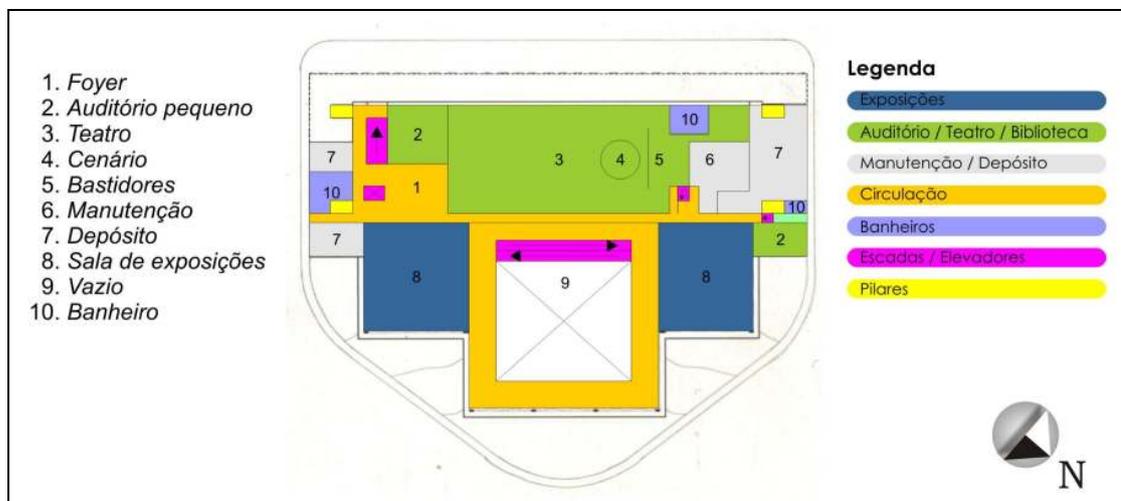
Planta baixa do 1° nível de subsolo (adaptada de BARDI, 1992).
